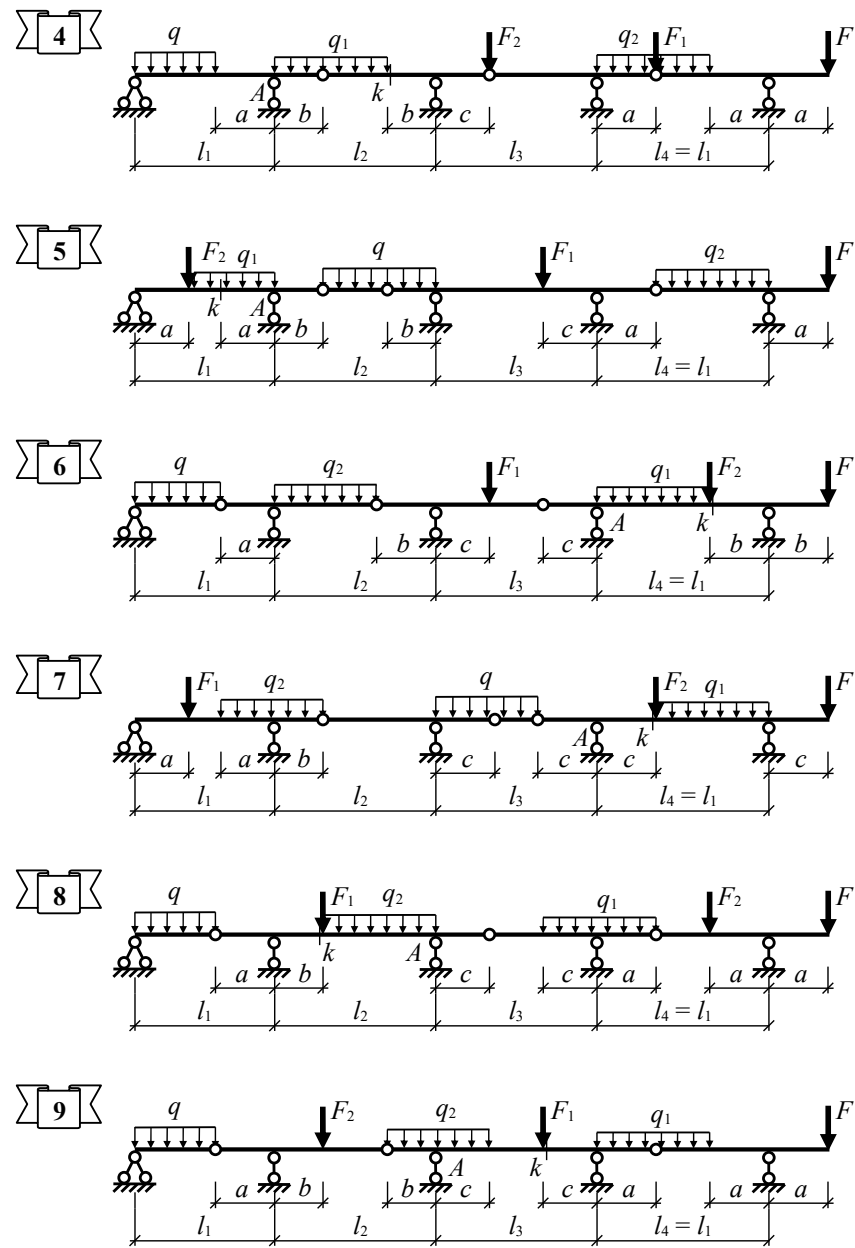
Расчетные схемы рамы шарнирно-консольных балок (окончание)
